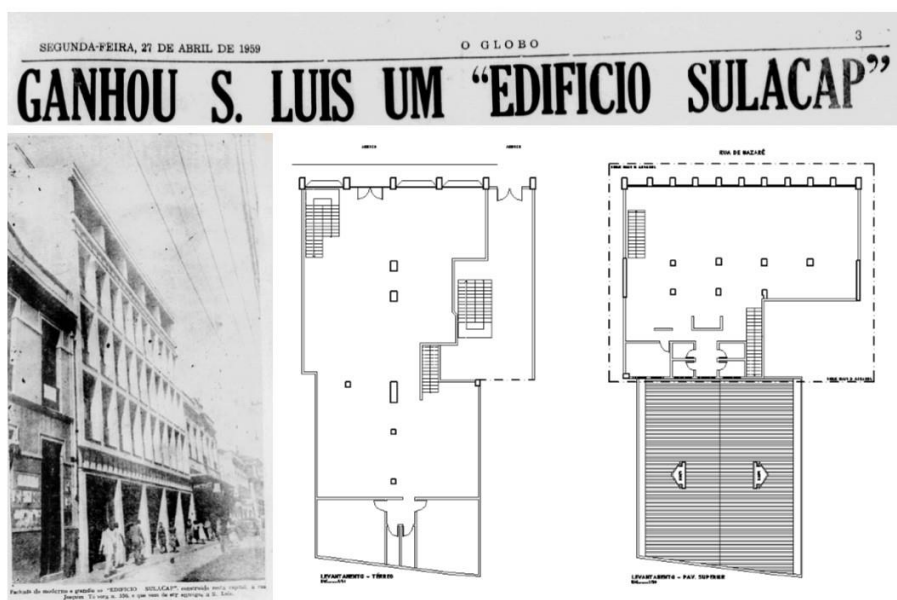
Edifício Sulacap (Autor desconhecido, São Luís, 1959): vista da fachada e plantas baixas do térreo e pavimentos superiores. Fonte: O Globo, 1959 (fachada) e arquivo pessoal Walber Filho (plantas).
